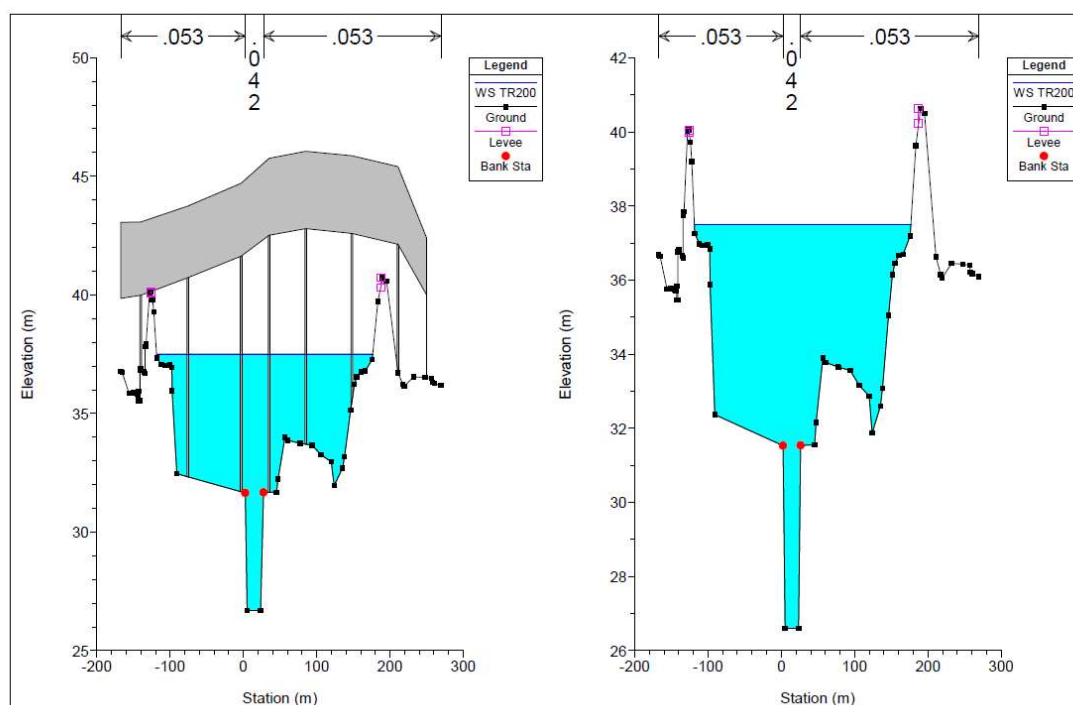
Sezione 10.8 (a sinistra) e sezione 10.7 (a destra), stato di progetto
